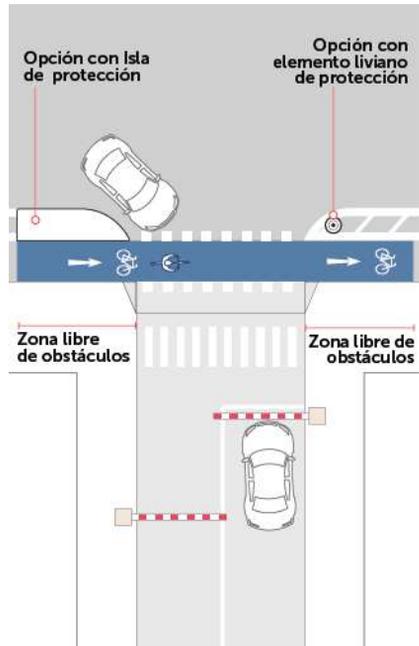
Acceso vehicular con islas de protección. Fuente: Elaboración propia adaptado de Separated Bike Lane Planning and Design Guide (p.90), por Federal Highway Administration, 2015.
